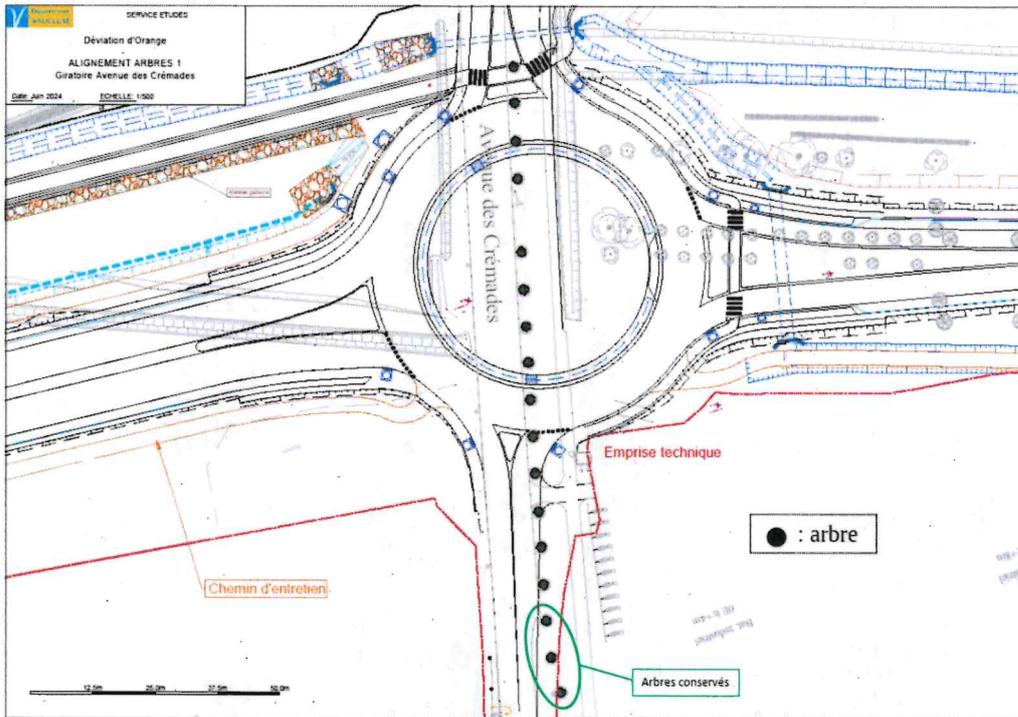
Plan du giratoire de l'Avenue des Crémades - alignement 1 (CD84)
